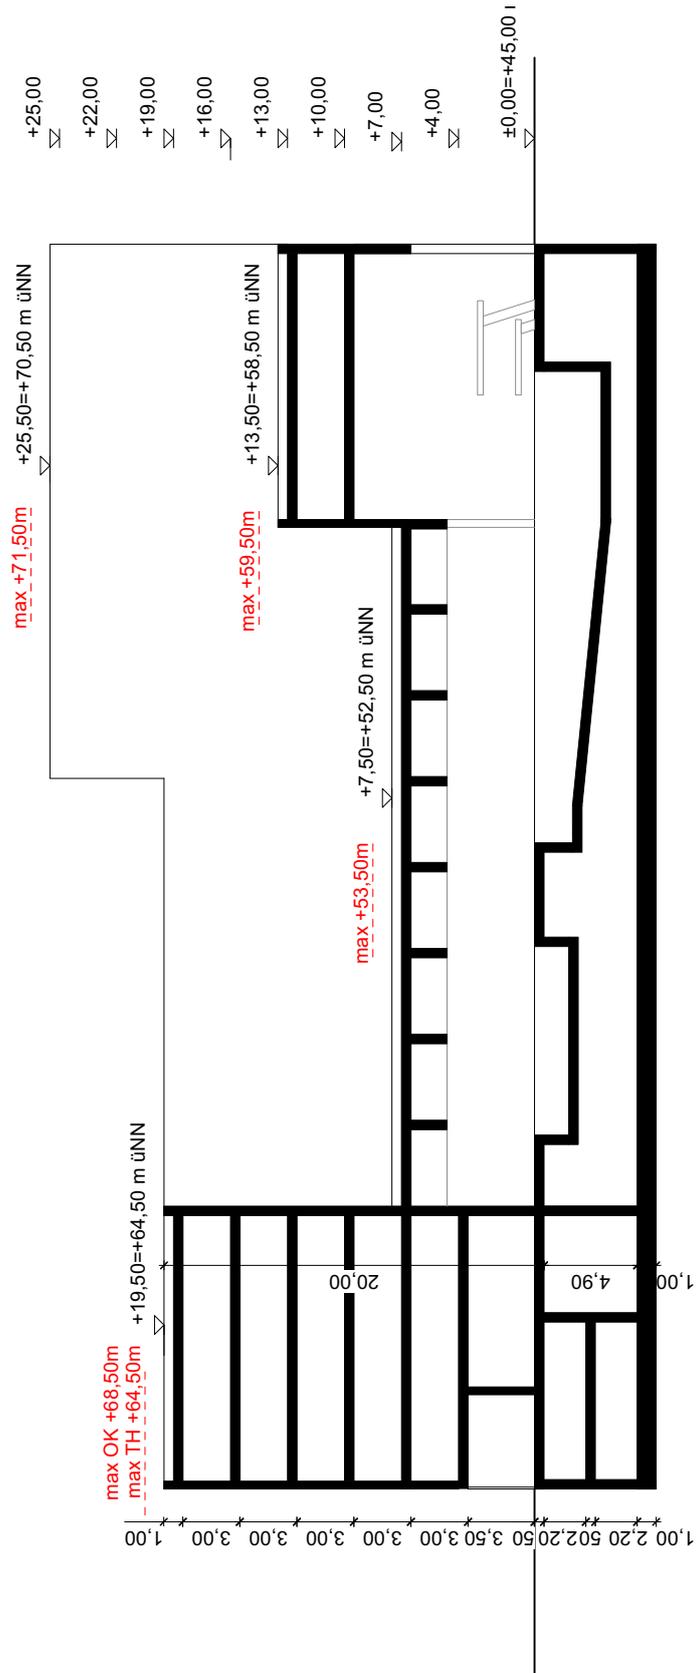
Schnitt Längsschnitt Variante 2, M 1:400
